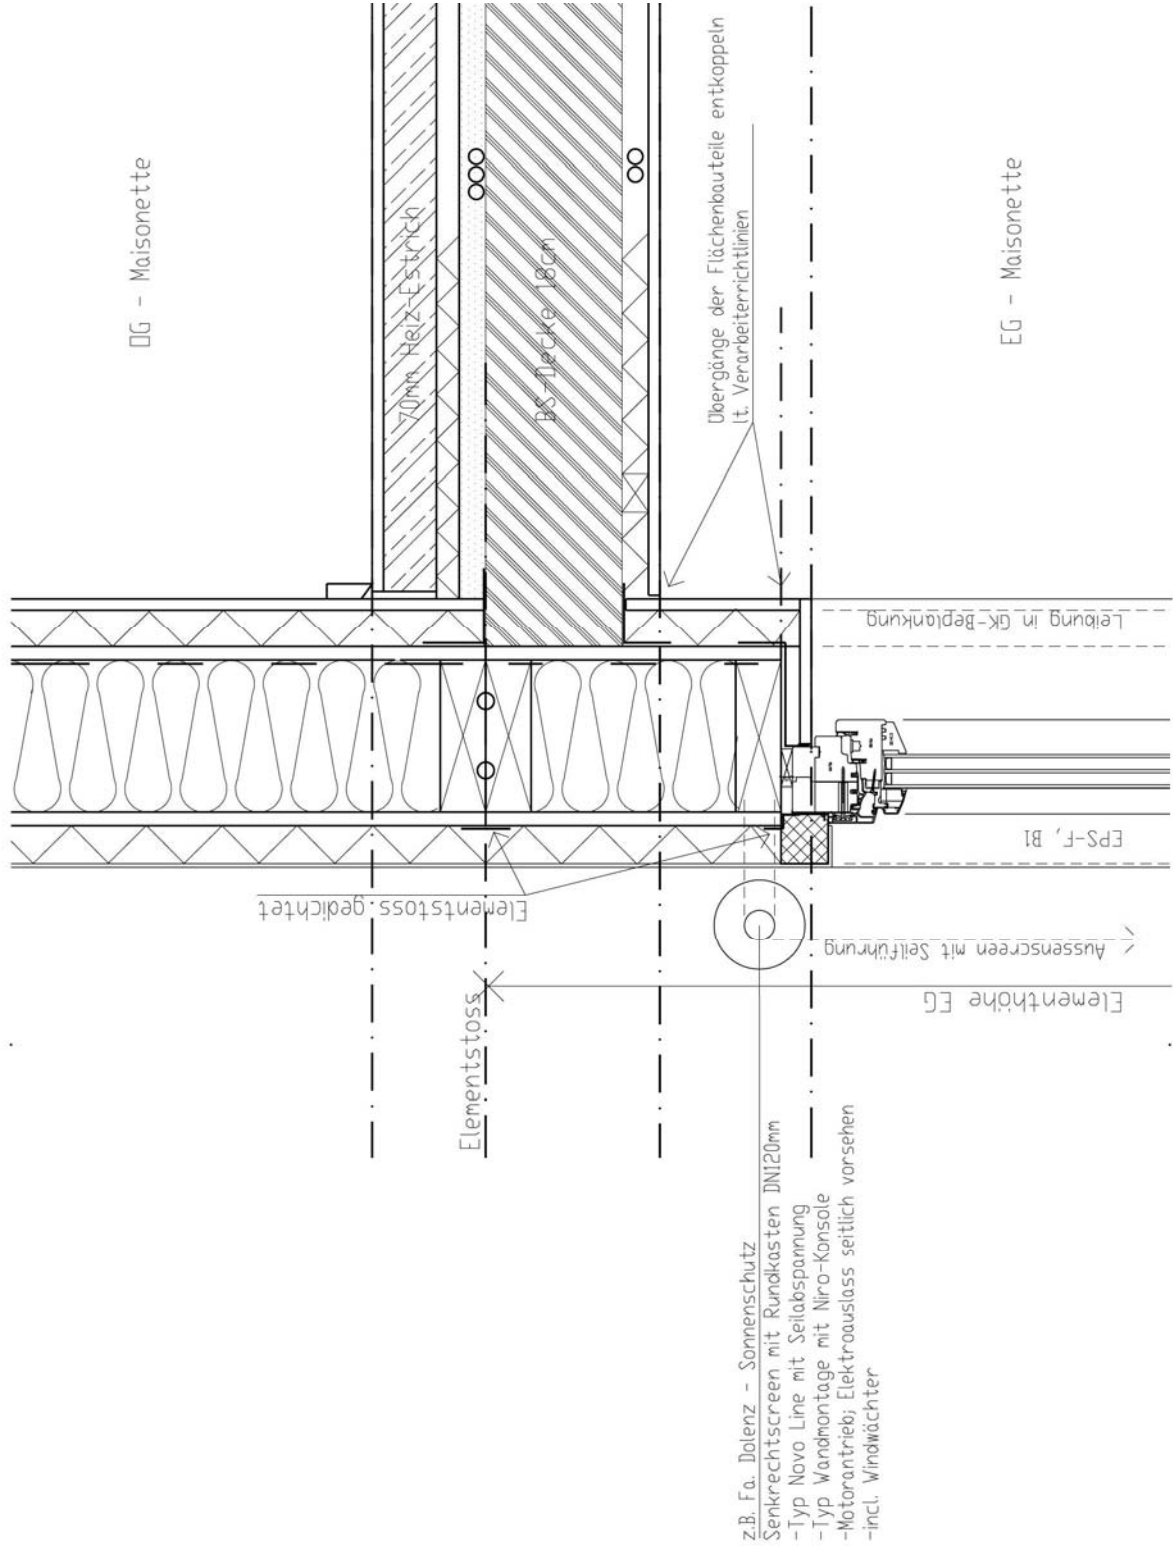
Baudetail Projekt "Smart Housing" Außenwand/Geschoßdecke Det.01
